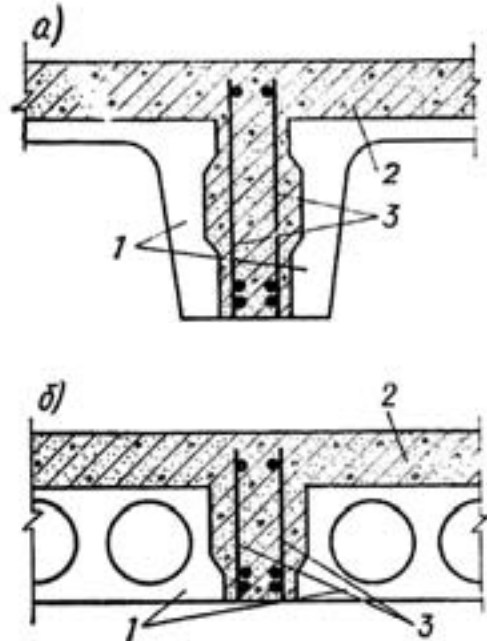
Схема розміщення арматурних каркасів між збірними елементами збірно-монолітного перекриття сховища:
